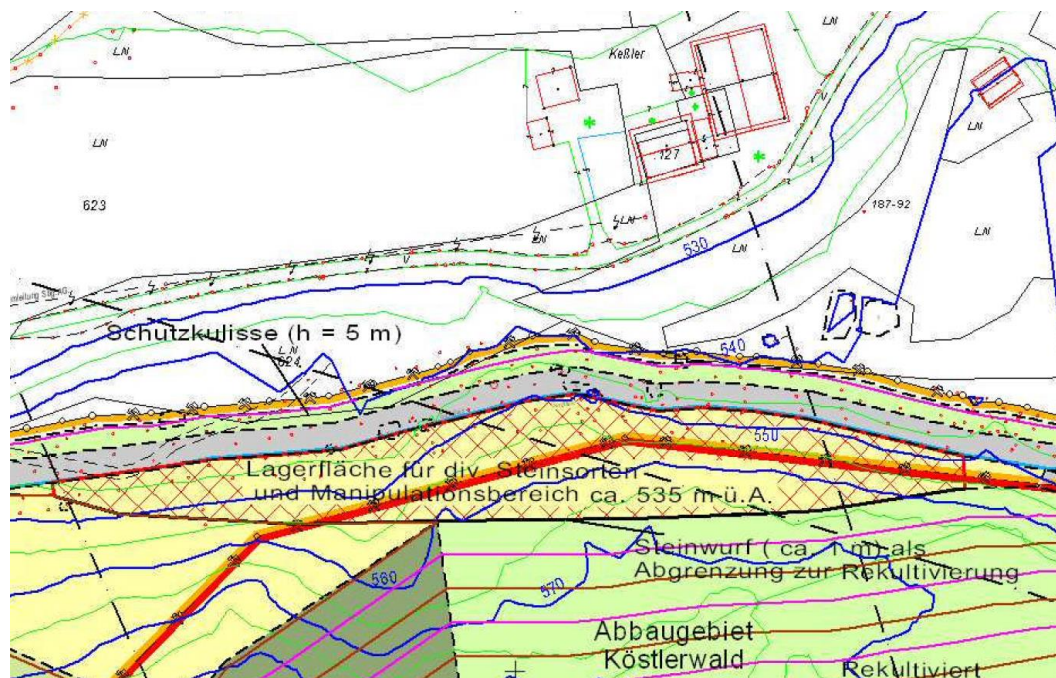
Lager- und Manipulationsfläche, Lageplan (Etappe 2)
